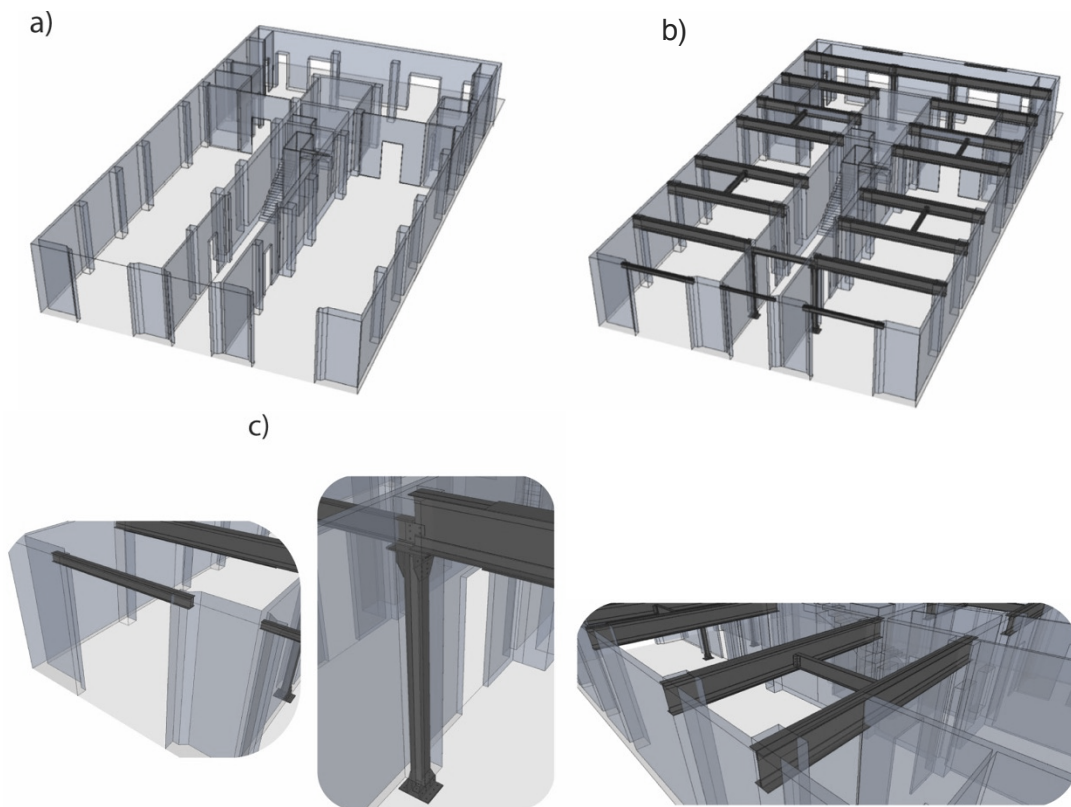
a) Espacio diáfano para uso comercial o de restauración en planta baja; b) uso de jácenas y pilares en sustitución de muros de carga; y c) detalle de dinteles, pilares y jácenas empleados en planta baja (fuente: elaborado por el autor)
